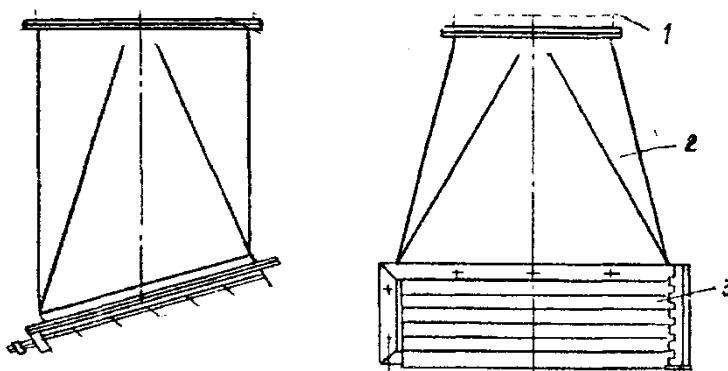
Душевой патрубок с верхним подводом воздуха типа ПДВ: 1 - воздуховод; 2 - корпус; 3 - направляющая решетка
